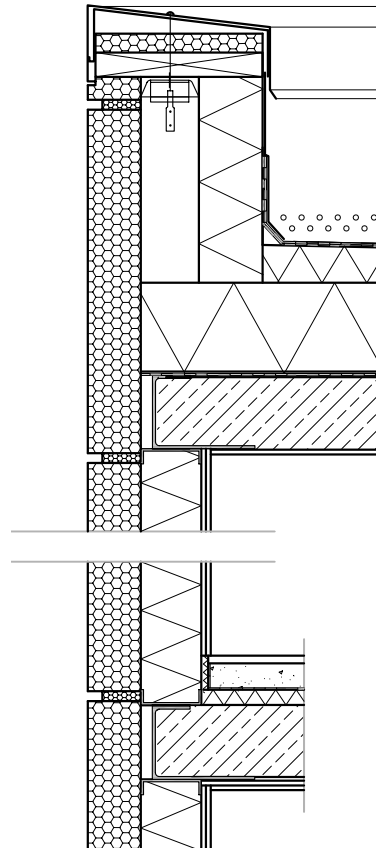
Schnitt Attika, Aufbau 6b, M. 1:20
